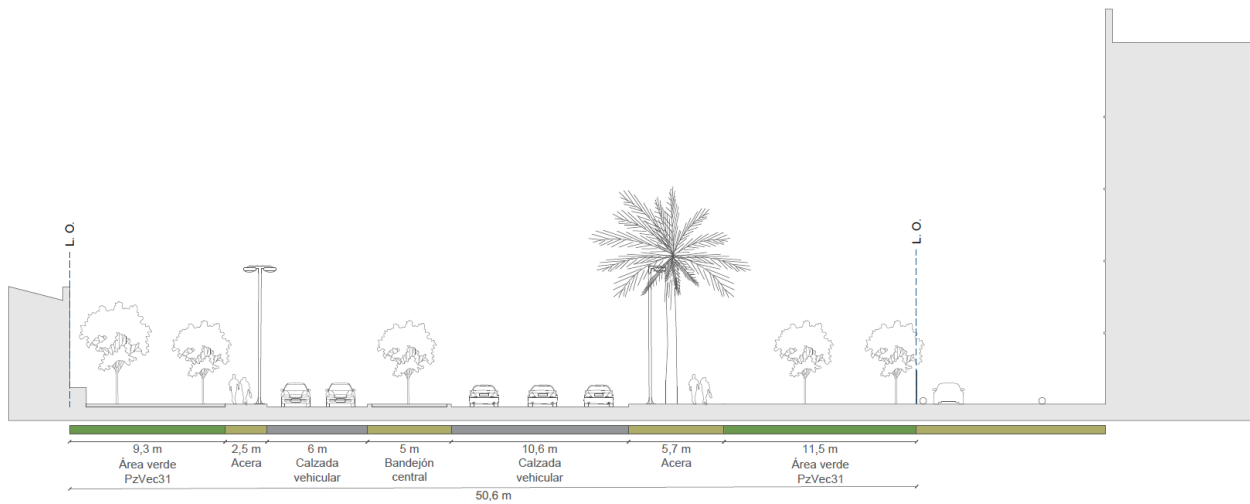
Perfil N-N' Dr. Hernán Alessandri. Situación existente. Fuente: Elaboración propia.
